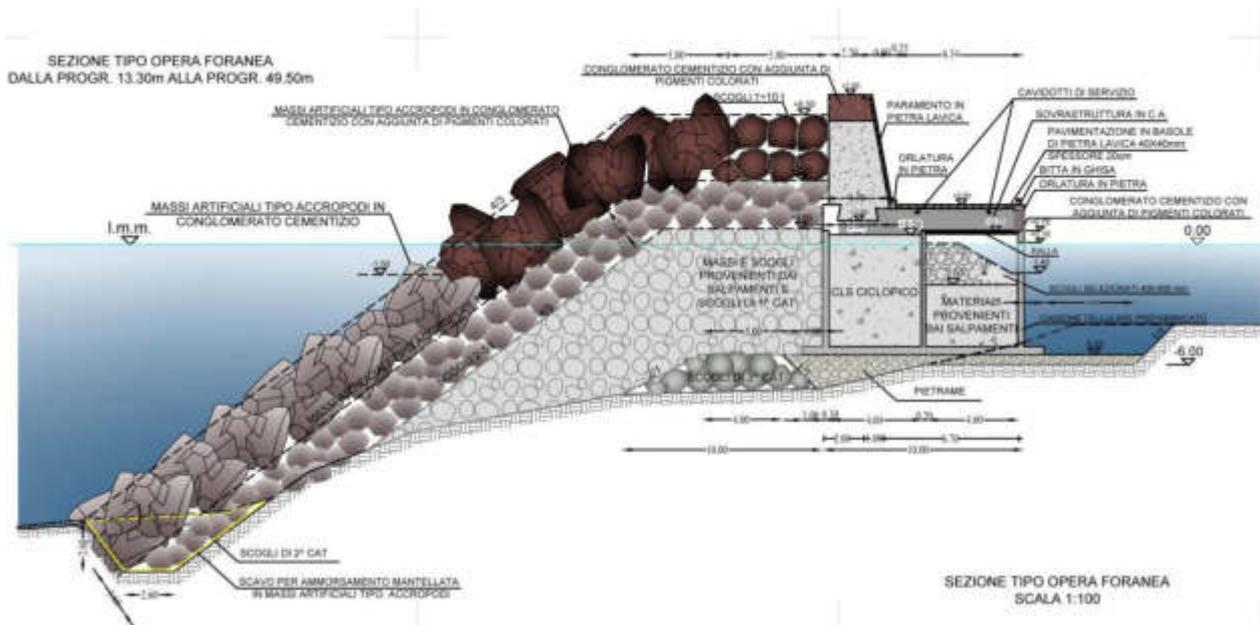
Sezione - Progetto 1° Stralcio funzionale del 2006
